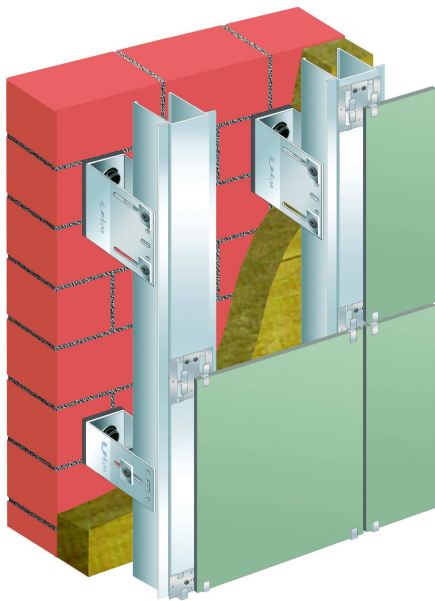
Схема навесной фасадной системы с воздушным зазором «U-коп» АТС-234 с облицовкой из плит керамогранита с видимым креплением.
